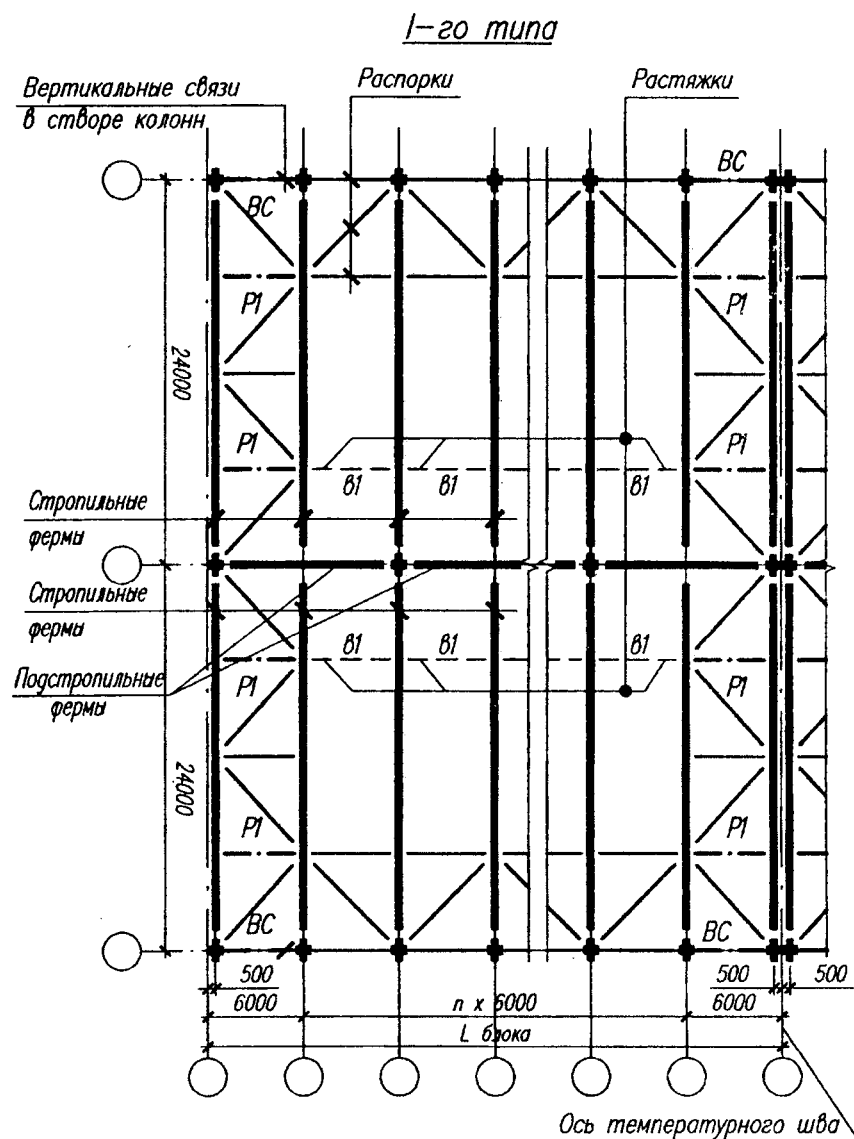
Схема расположения связей по нижним поясам стропильных ферм (шаг ферм 6 м)
